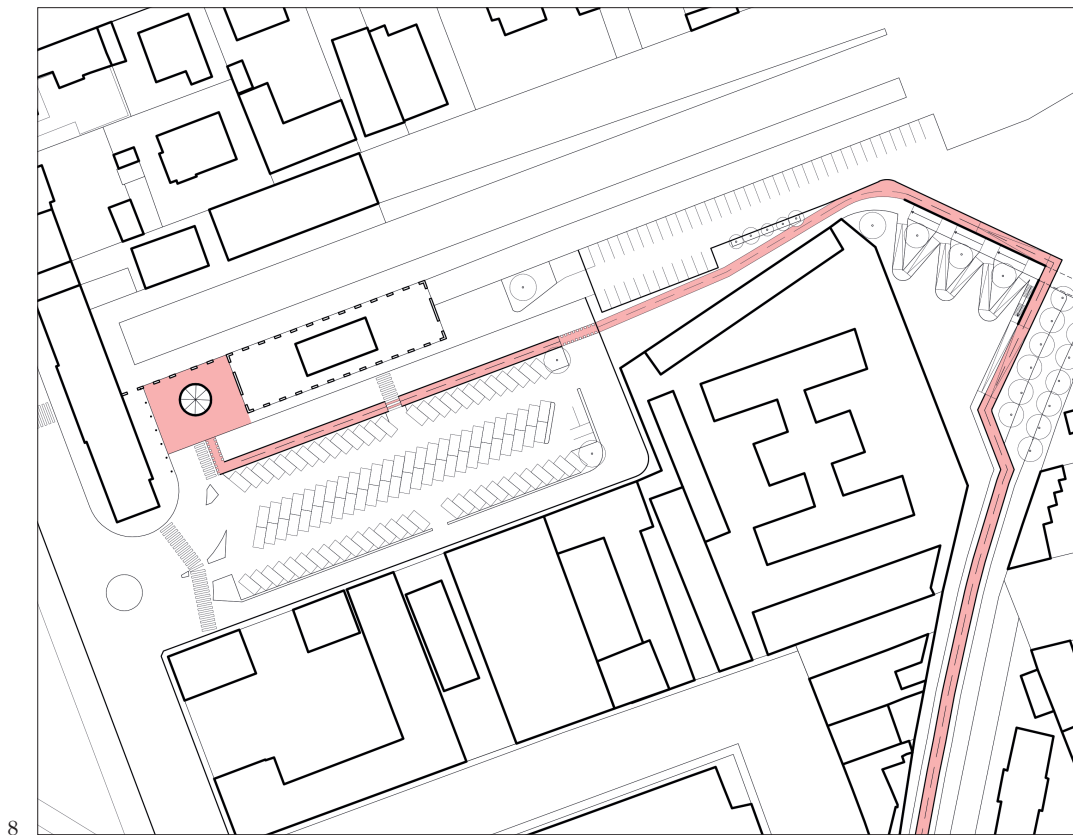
Planimetria di progetto per il piazzale della stazione di Pinerolo.
